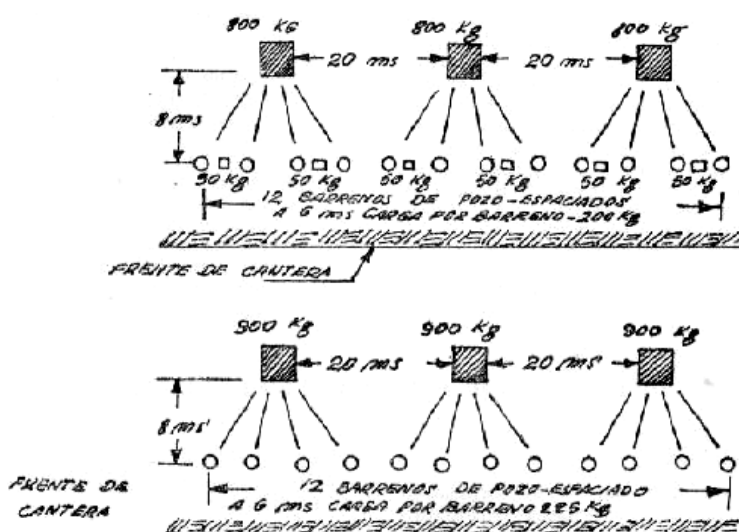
Planos para distribución de explotación en la zona de trabajo con barrenos verticales
